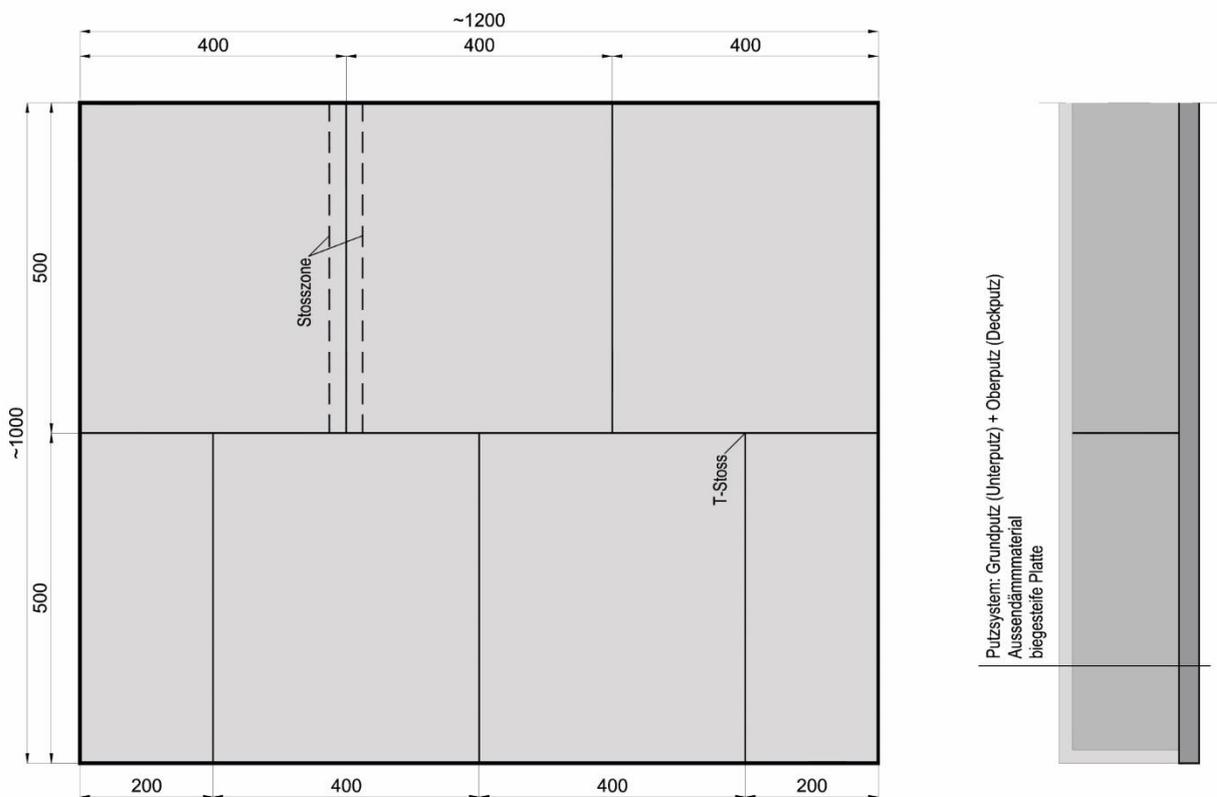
Grundriss und Schnitt eines möglichen Versuchsaufbaus. Putz mit mehreren Aussendämmplatten
